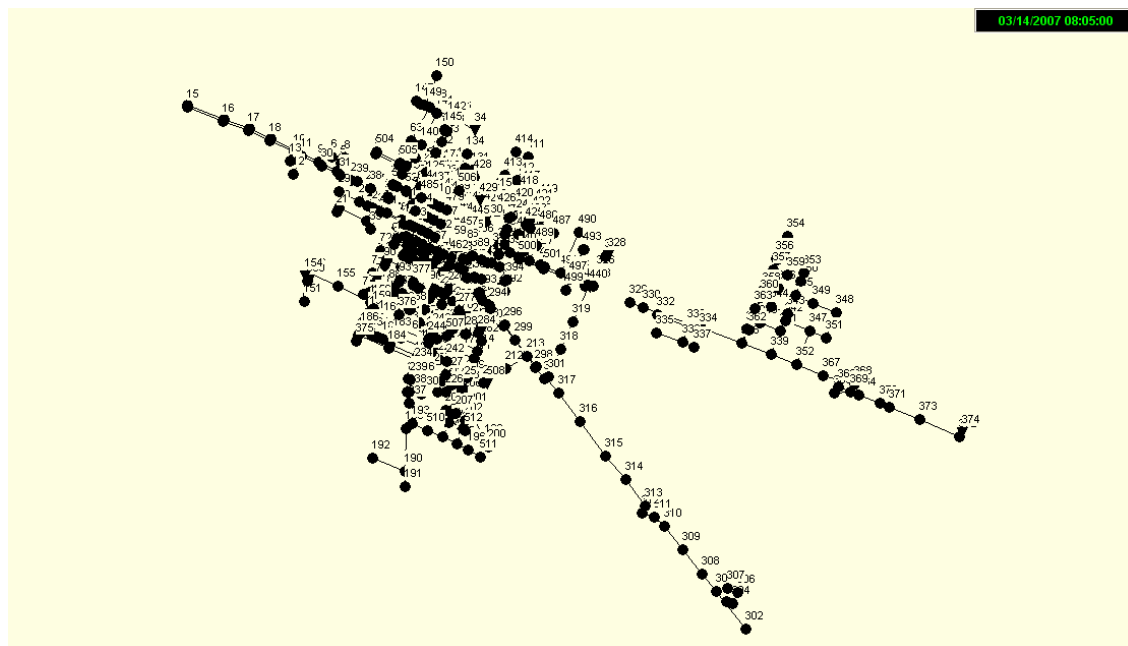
Planimetria rete fognaria di Crevalcore
